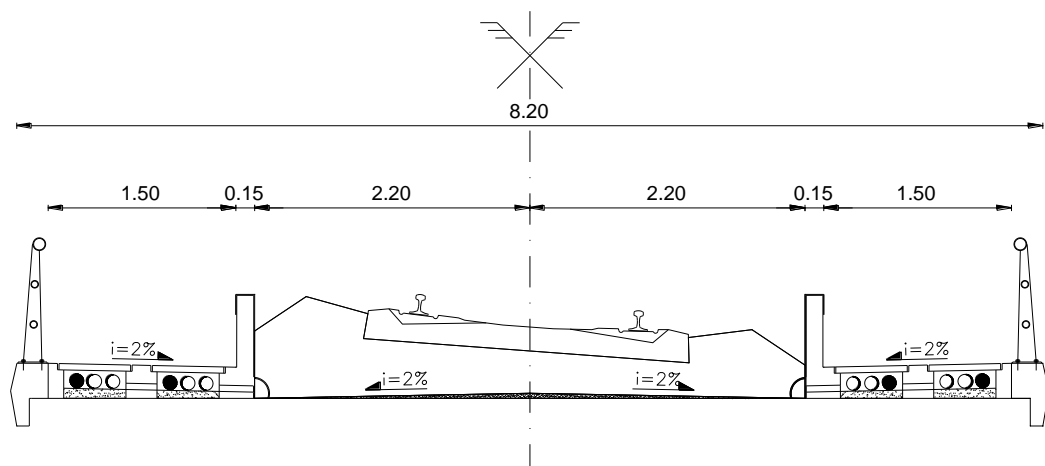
PERFIL TRANSVERSAL TIPO DO VIADUTO FERROVIÁRIO
